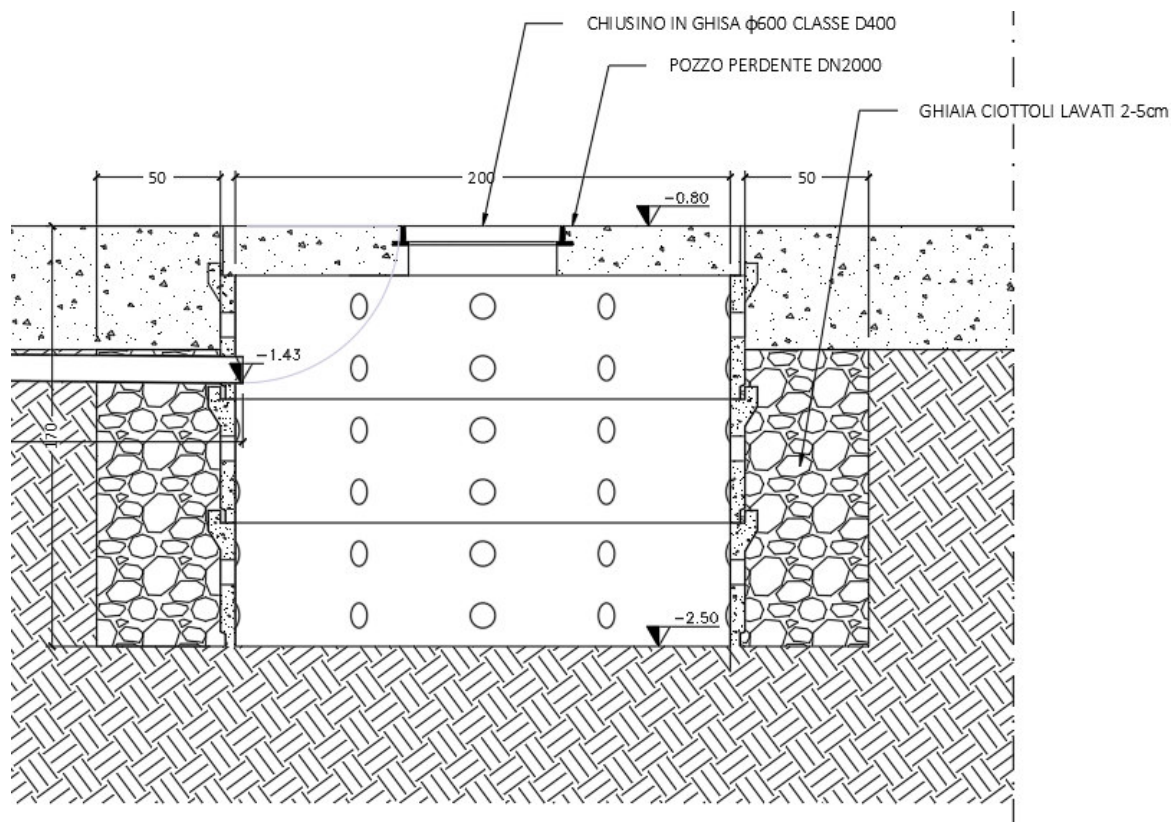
Tubazione interrata più bassa entrante nel sistema di laminazione
